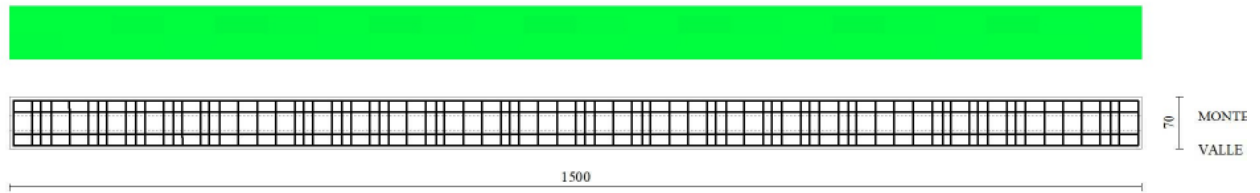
Piastra fondazione dir. Y (Inviluppo)
